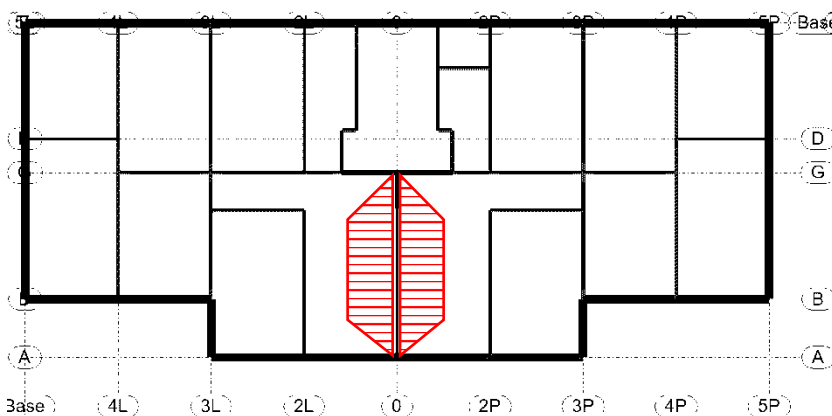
att. Betona sienas un dzelzsbetona sienas paneļa stiegrojuma daudzuma principiālā atšķirība
